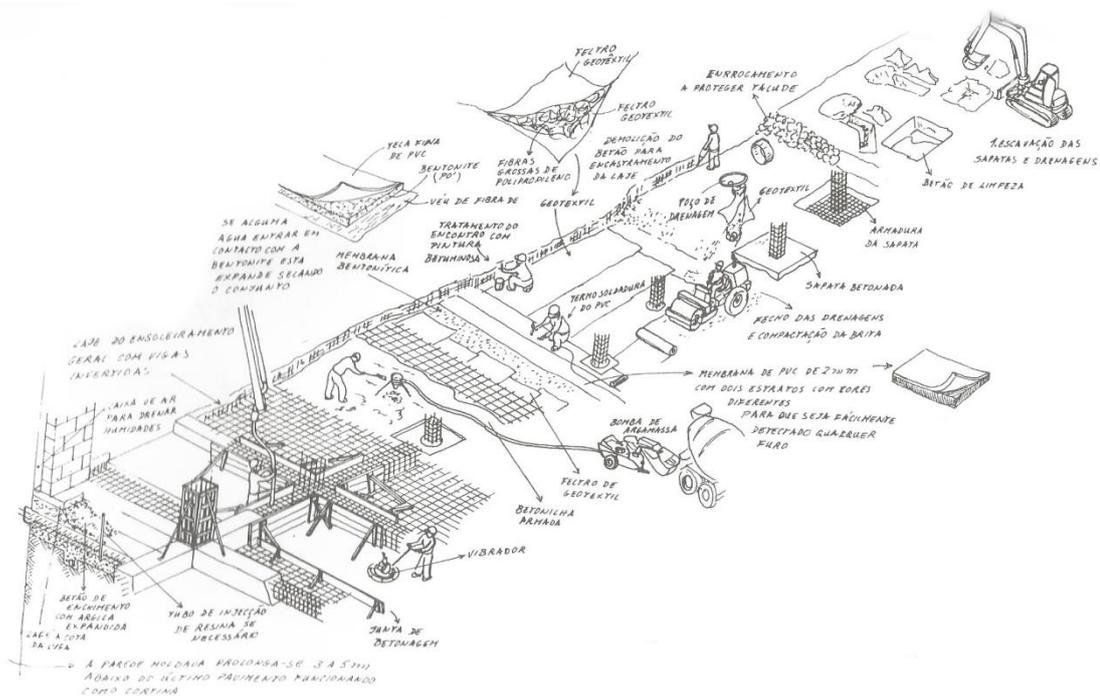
Imagem descritiva do processo construtivo na construção da primeira laje.
